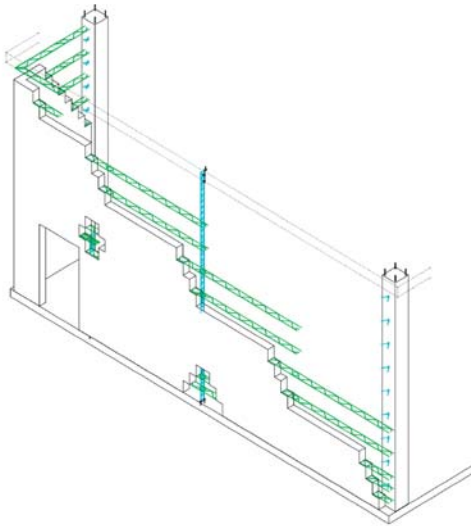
b) Costillas AllWall distanciadas a 2,80m entre sí, dispuestas en llaga vertical continua (en muro cortafuego doble de la Terminal T4 del Aeropuerto Madrid-Barajas).
